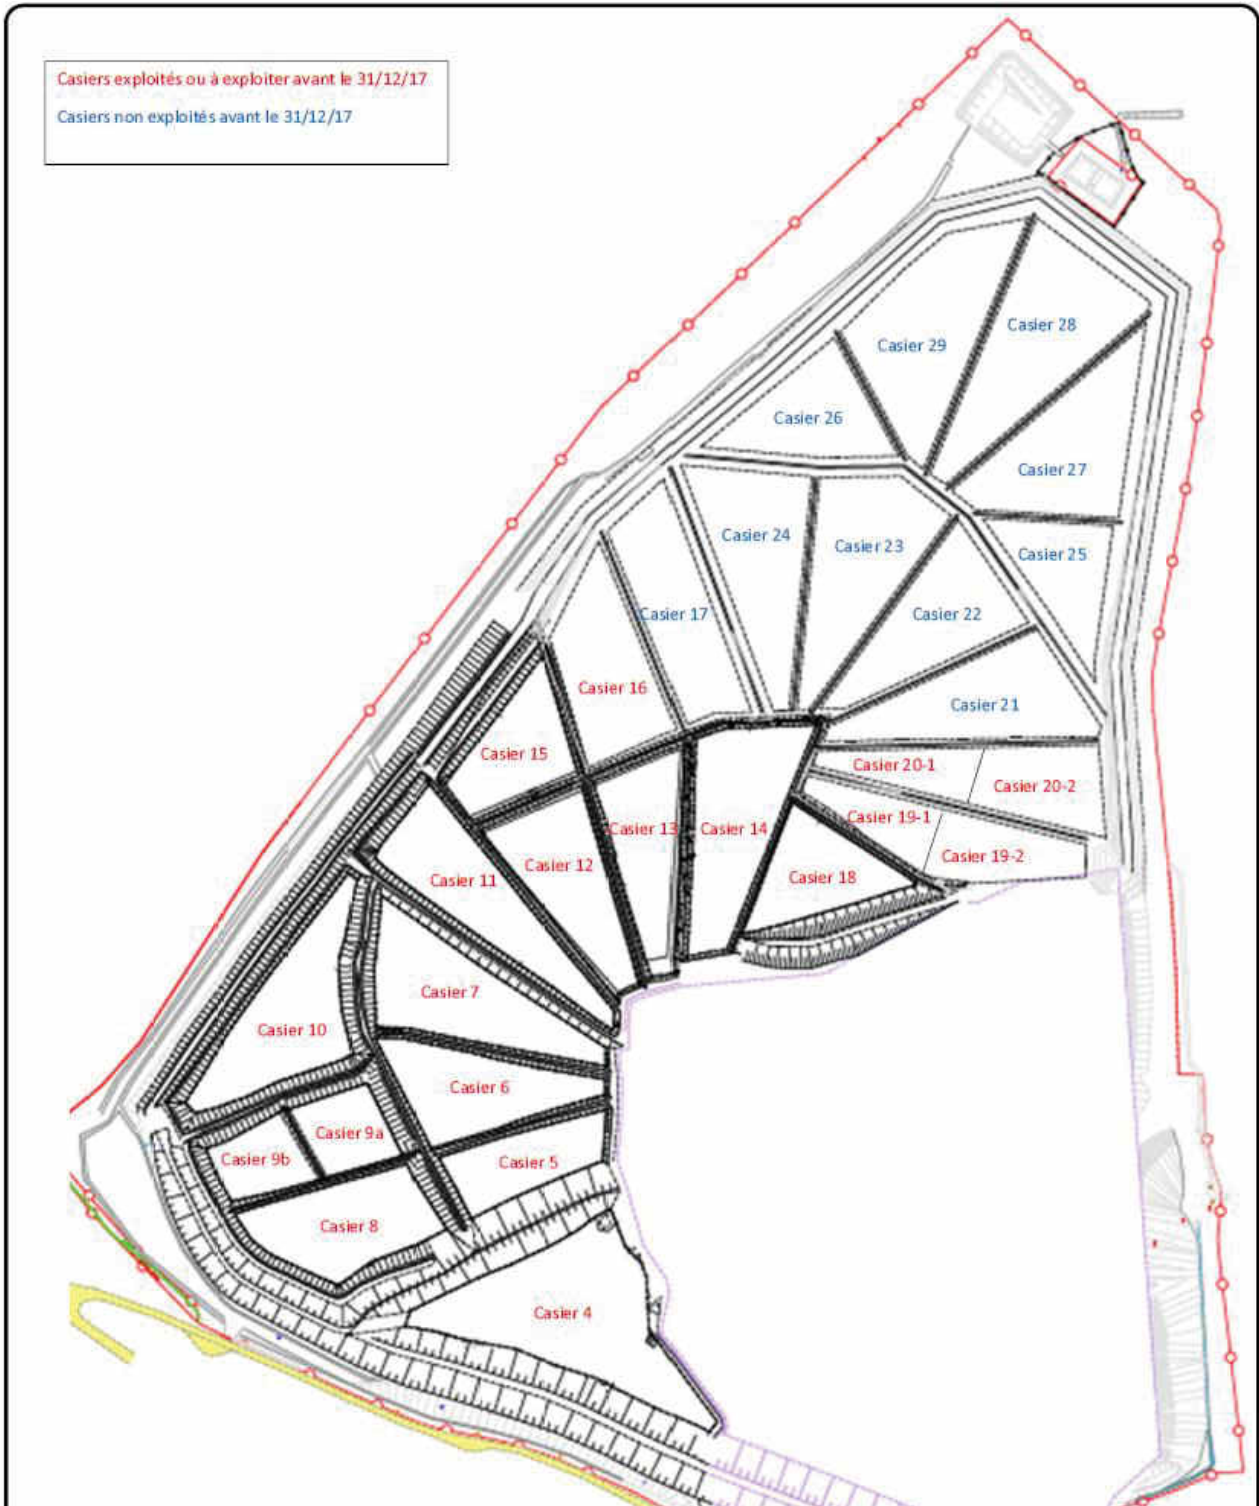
A : Plan des subdivisions en situation autorisée (source : KALIES, 2017)
